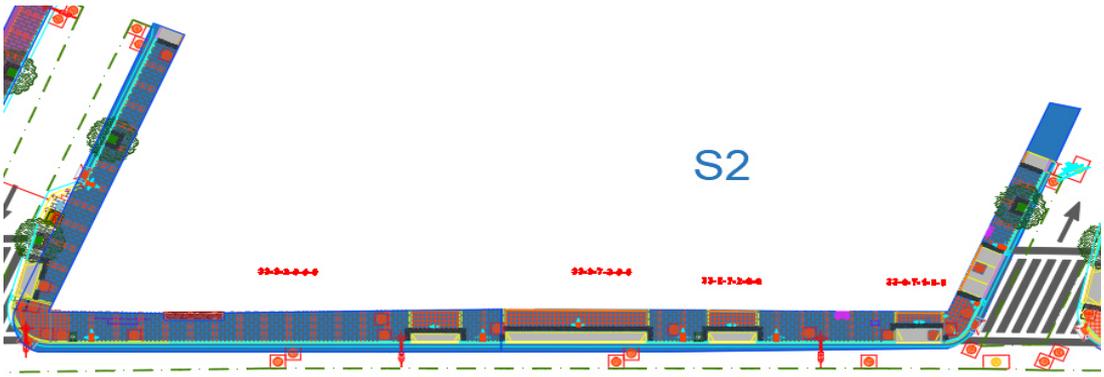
Vista en planta del tramo 1 hasta el tramo 3 de la Obra de Regeneración Urbana San Jorge
